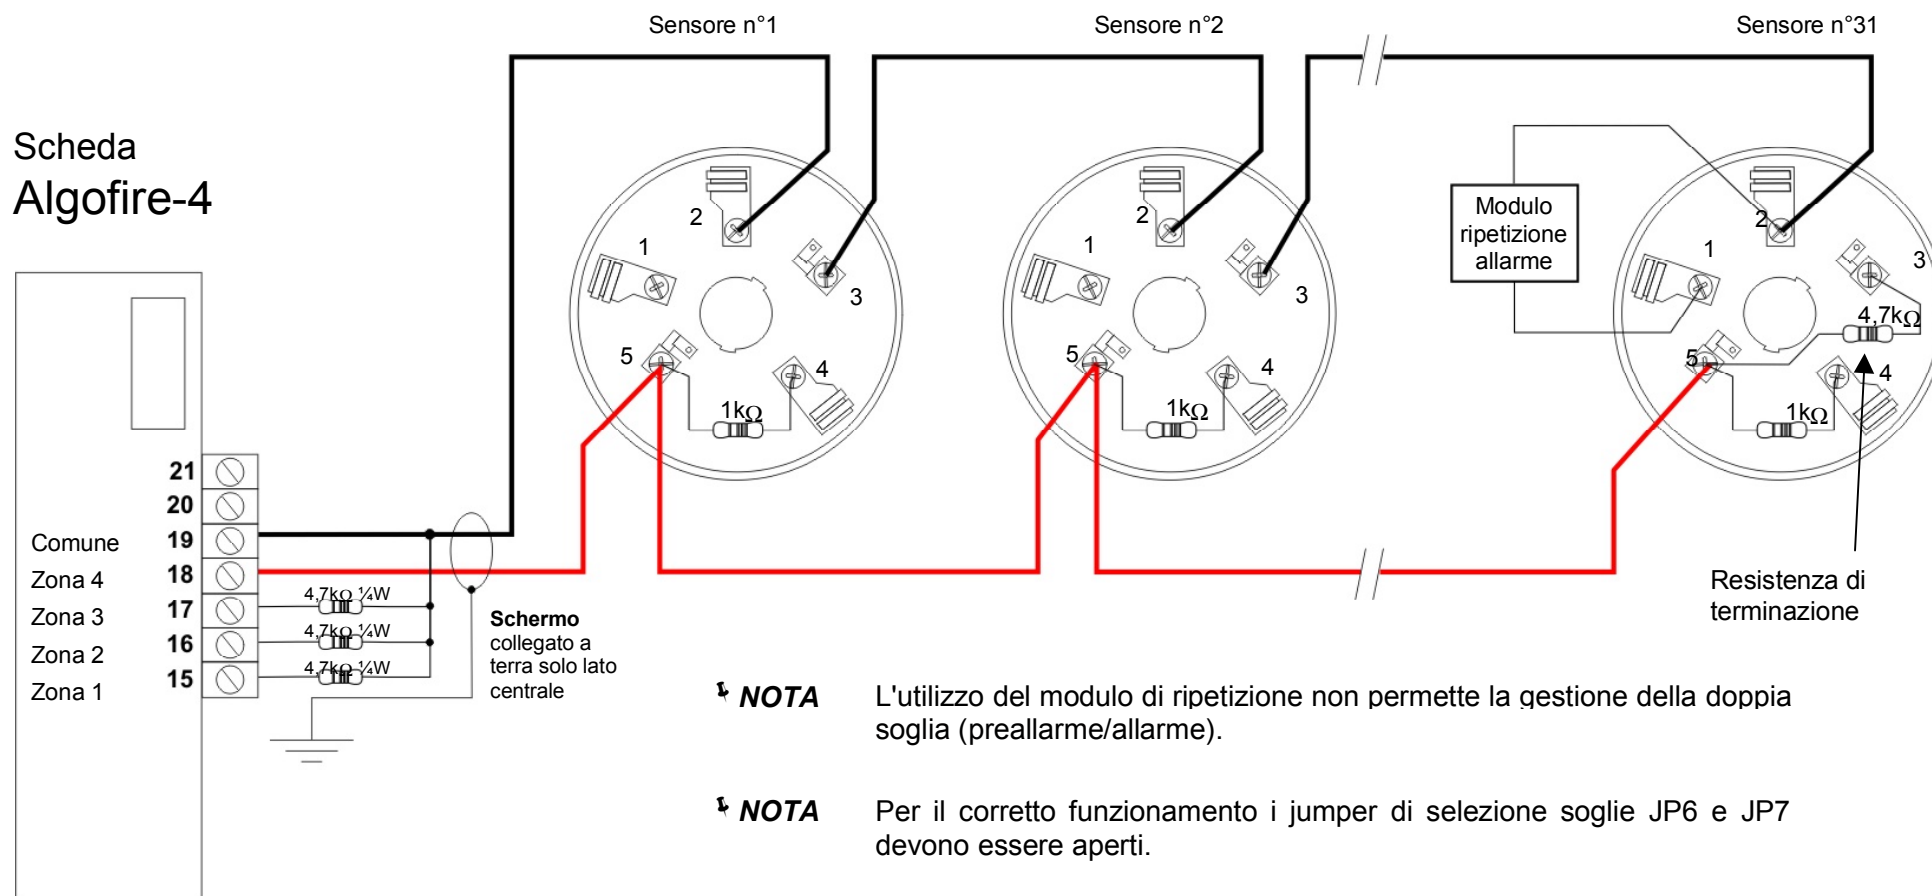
Esempio di collegamento sensori su zona 4 di centrale
